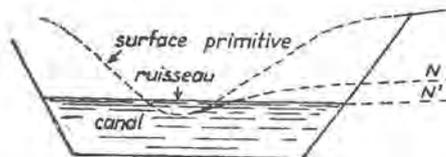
Abaissement du niveau d'une nappe d'eau de N à N' par le creusement d'un canal ou d'une tranchée.
